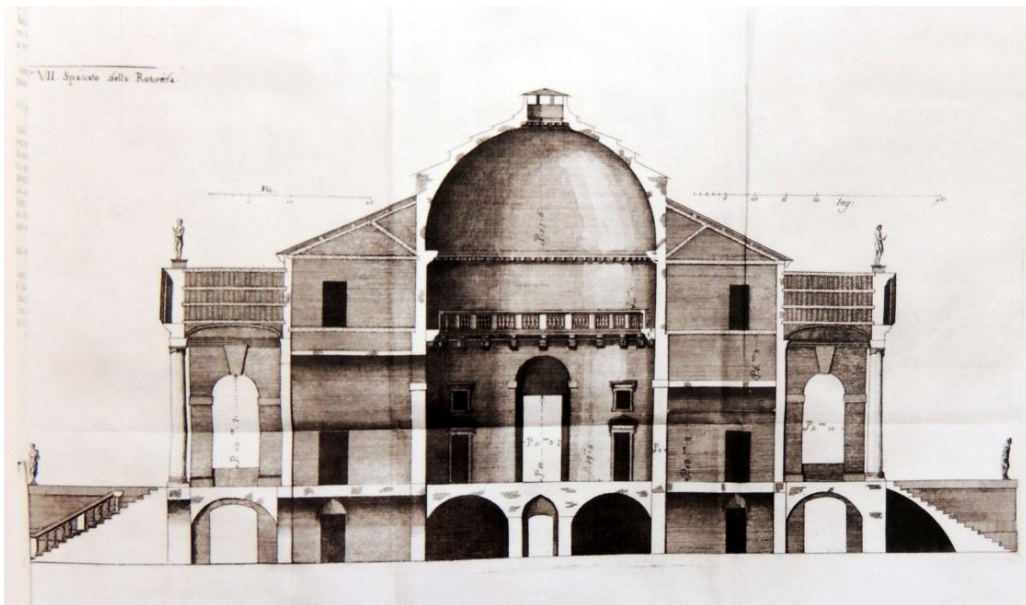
Corte transversal da Villa Capra (Rotonda) Vicenza, projetada por Andrea Palladio, 1566. (CALDEIRA, 2011, p. 73).
